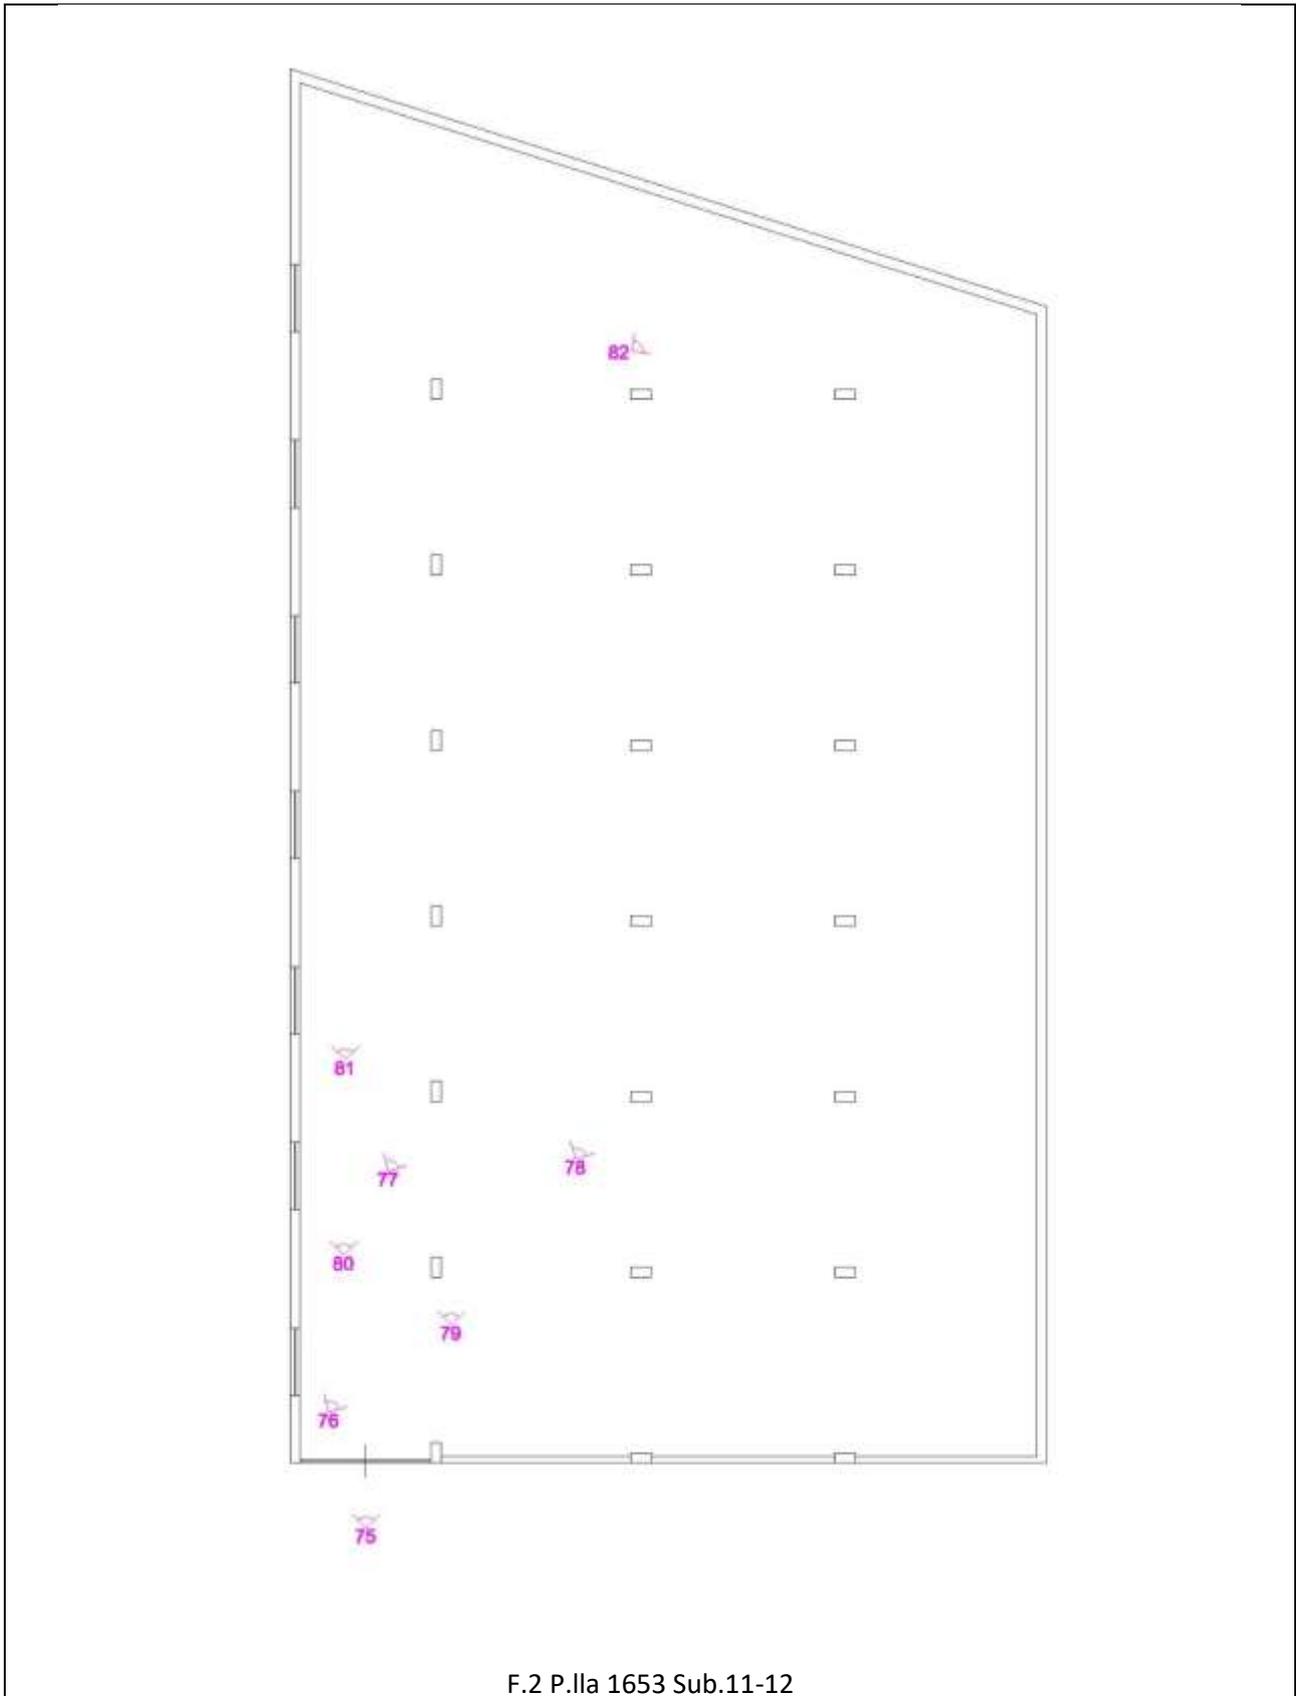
F.2 P.IIa 1653 Sub.11-12
